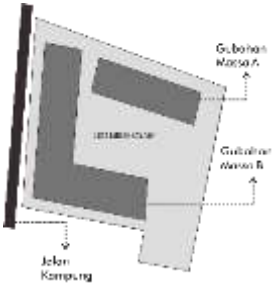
Bentuk Site dan Bentuk Rancangan Massa Bangunan
